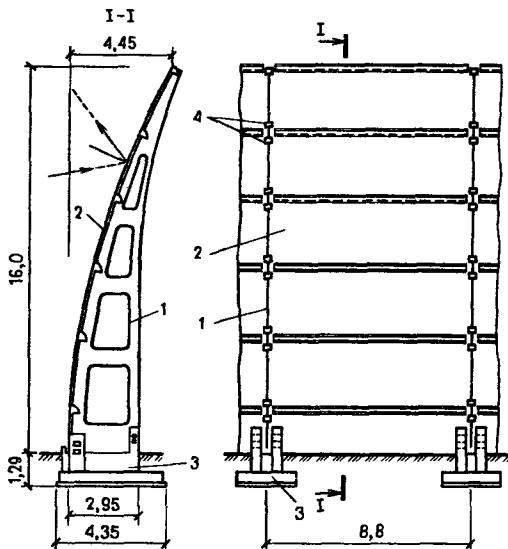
Конструкция шумозащитного экрана из железобетонных элементов заводского изготовления
